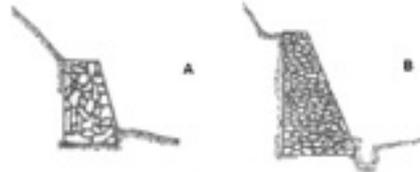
Muros de Gravedad. A) De piedra seca y B) De piedra argamasada.
